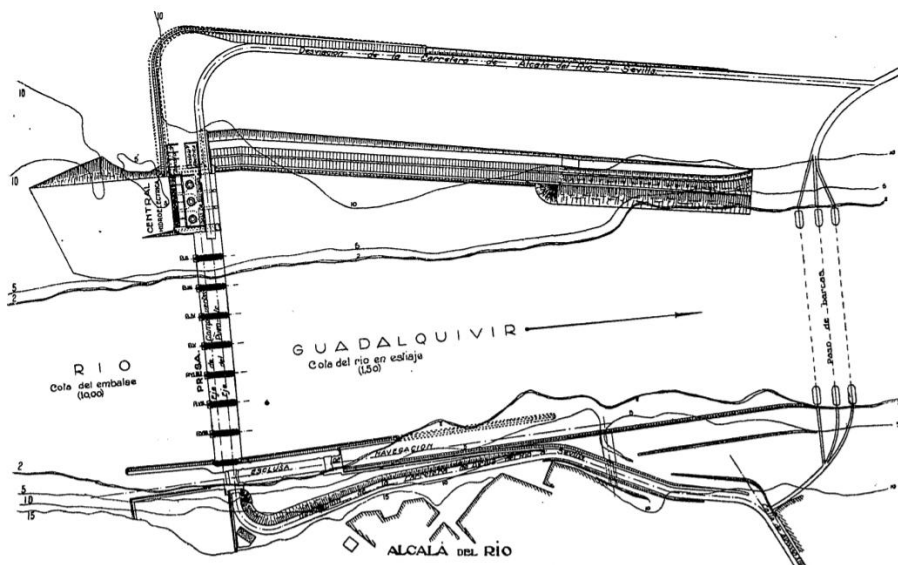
Planta general de la presa, esclusa y desviación de la carretera (Mendoza, 1926).
